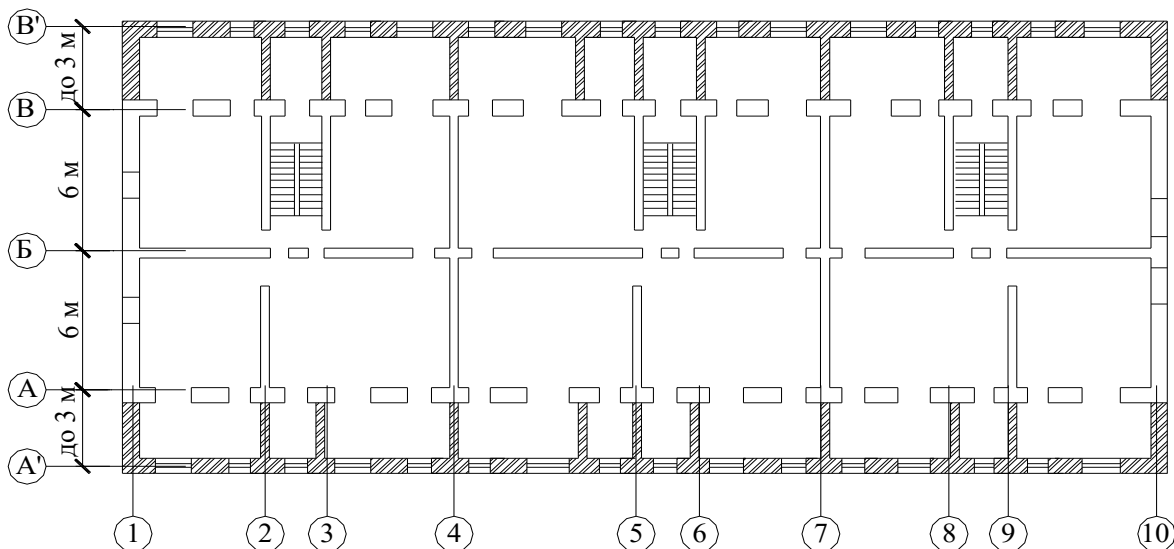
Схематичне зображення плану поверху житлового будинку серії 1-438 з урахуванням планованої реконструкції
